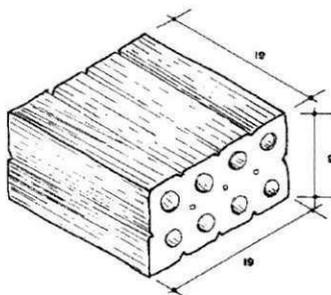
Tijolo Furado (Furo Cilíndrico)
